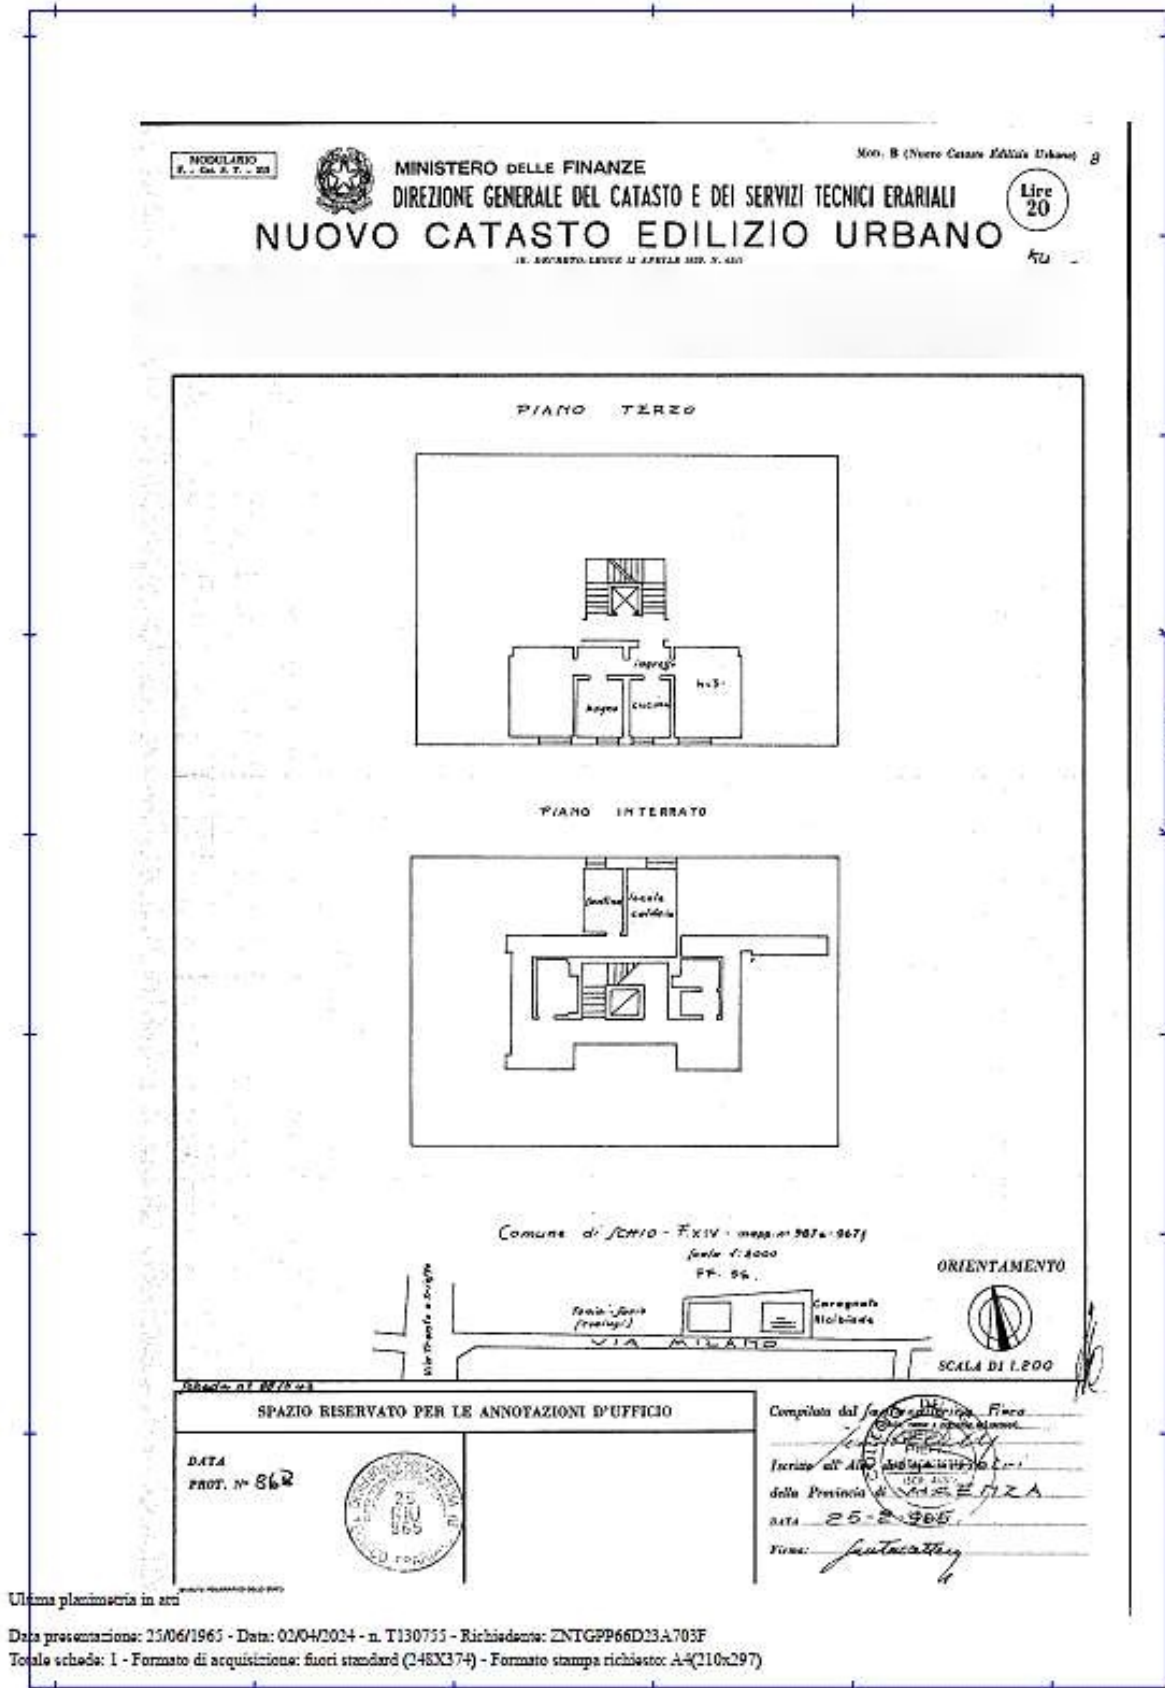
Planimetria appartamento piano terra e vani comuni al piano interrato
